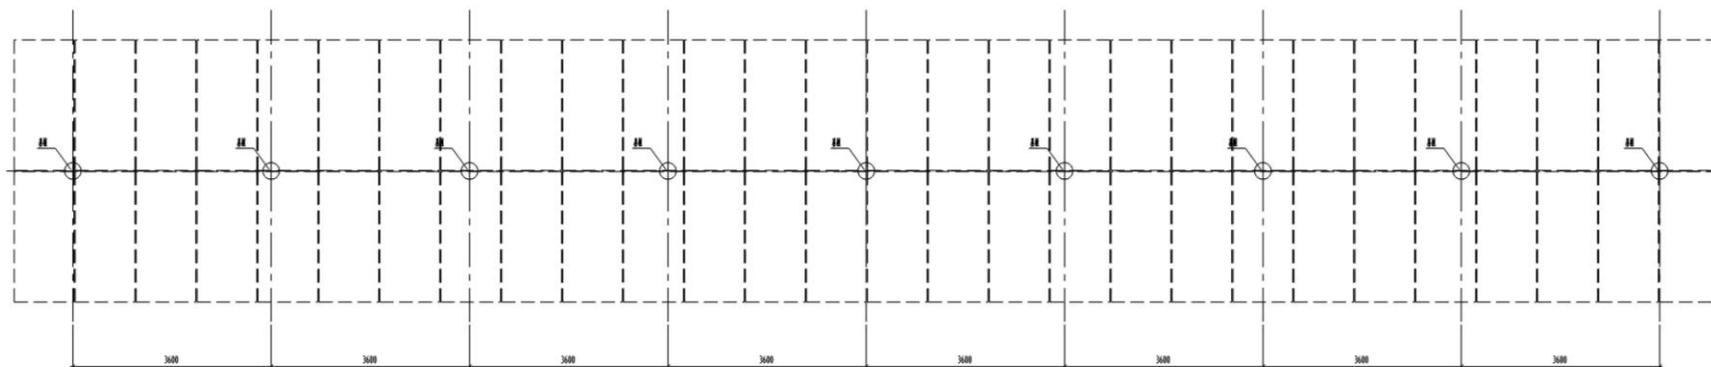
2×28 阵列光伏支架桩基础平面布置示意图
